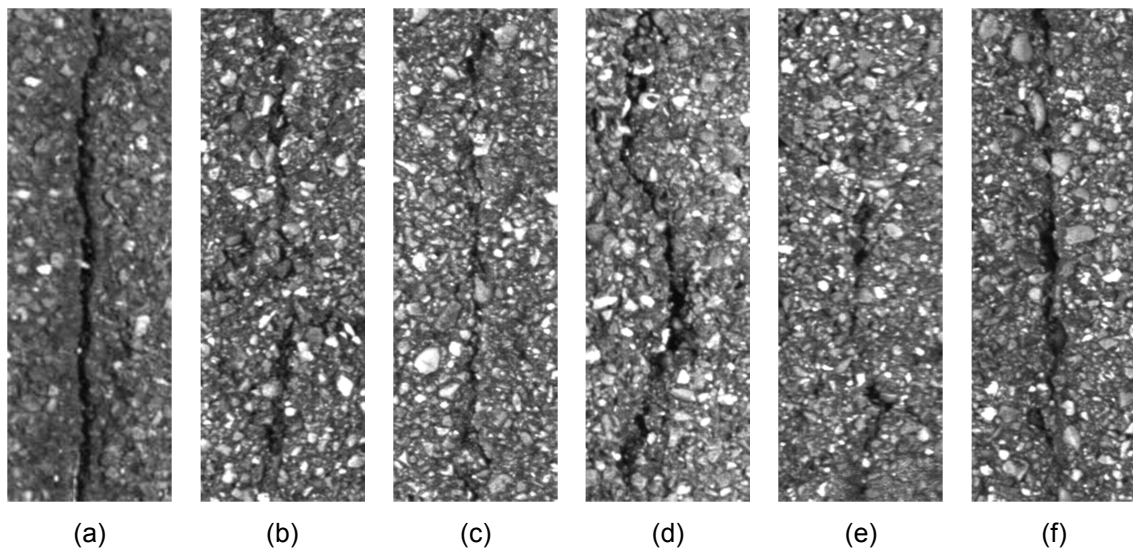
Imágenes de grietas longitudinales utilizadas en el entrenamiento
